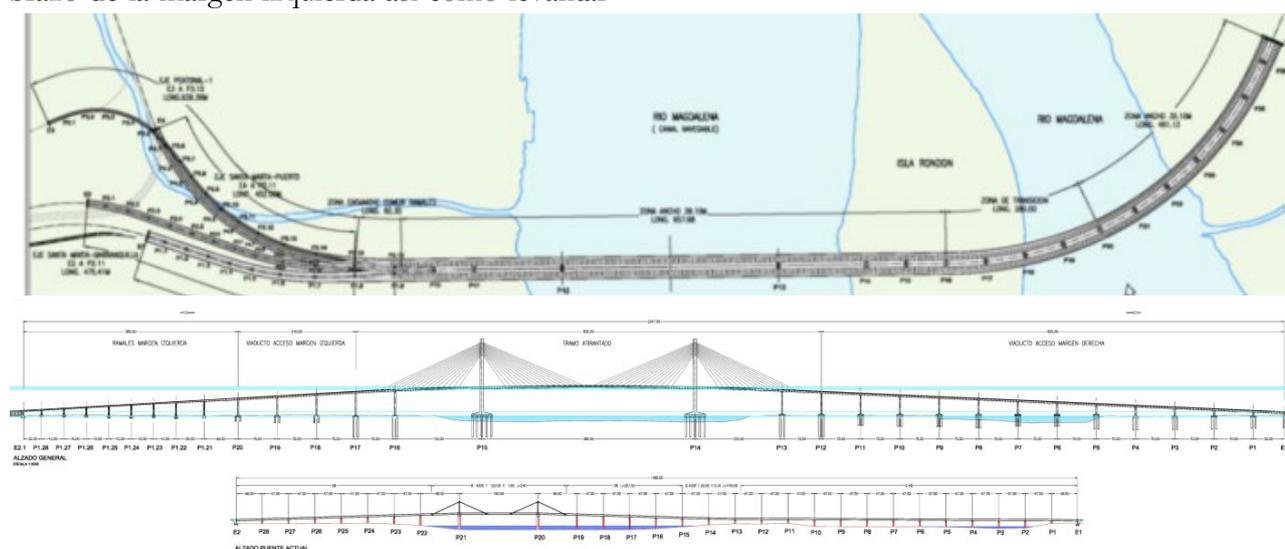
Planta y alzados comparativos del puente actual y de la nueva obra
